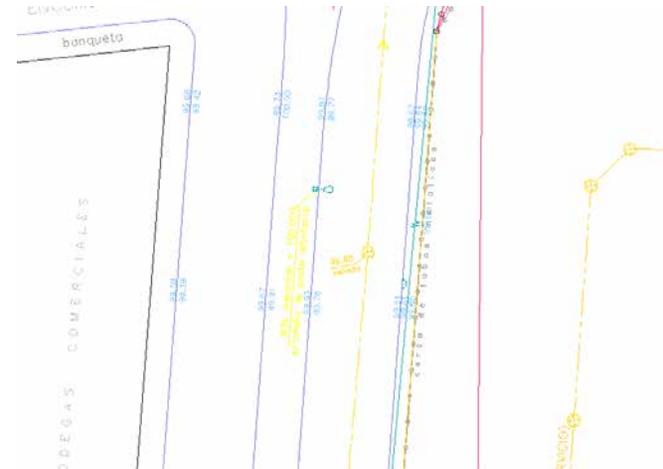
Av. Canal de Tezontle. Poste arbotante en camellón B.N. elevación=100.00. Poste y línea de teléfonos. Coladera pluvial En banqueta. Red de drenaje sellada y sentido.
